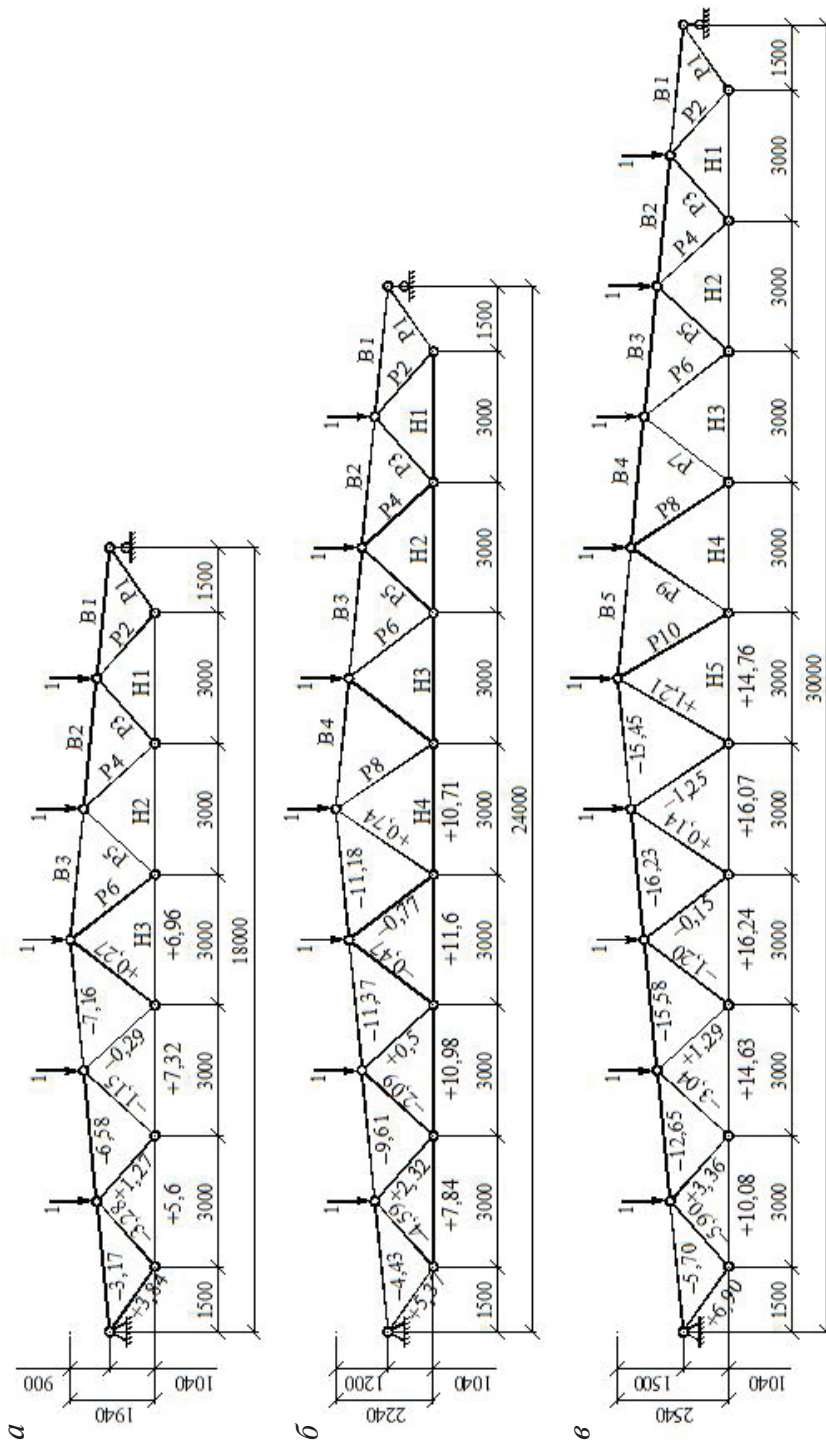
Обозначение стержней и усилия n_1 в стержнях ферм из гнуто-сварных профилей от единичной узловой нагрузки:
